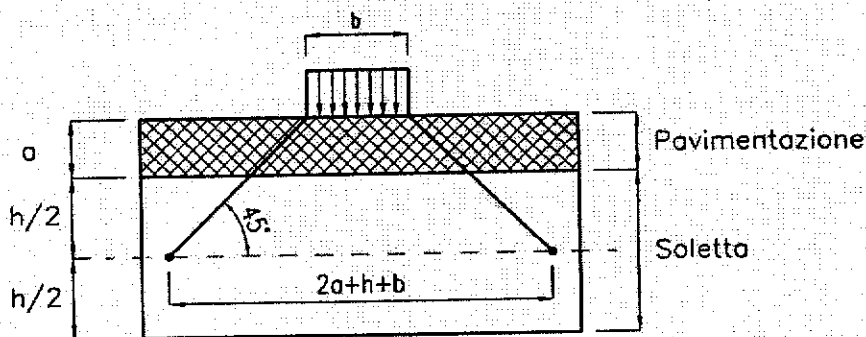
Diffusione dei carichi concentrati attraverso la pavimentazione e le solette
